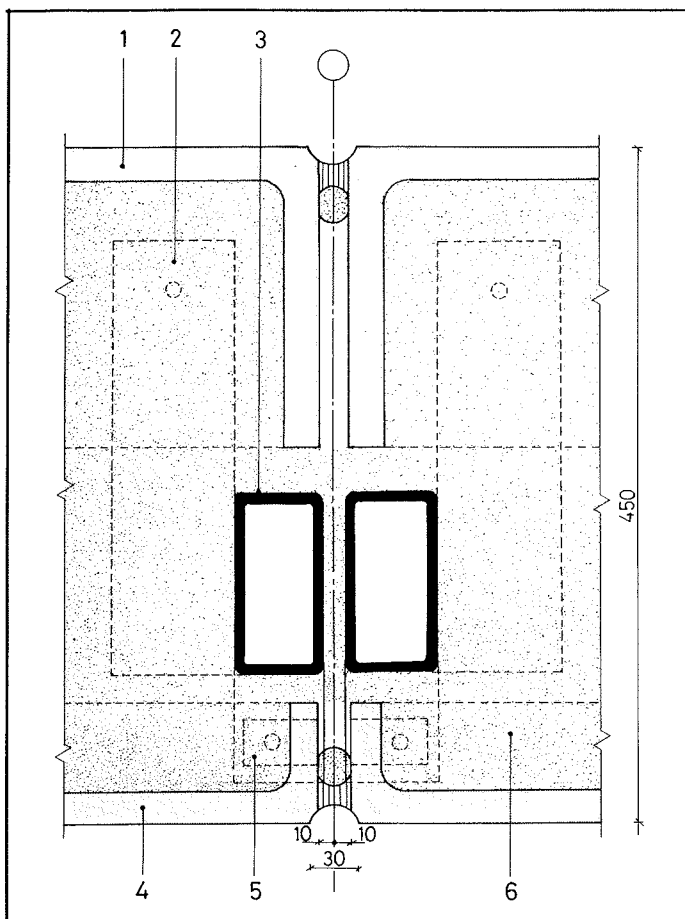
Vandret snit i fiberbetonvæg, 1:5. 1, udv. fiberbeton, 20 mm. 2, bærebælg for element. 3, RHS profil, 120 x 60 mm. 4, indv. fiberbeton, 20 mm. 5, beslag. 6, Rockwool hulrumsisolering.
